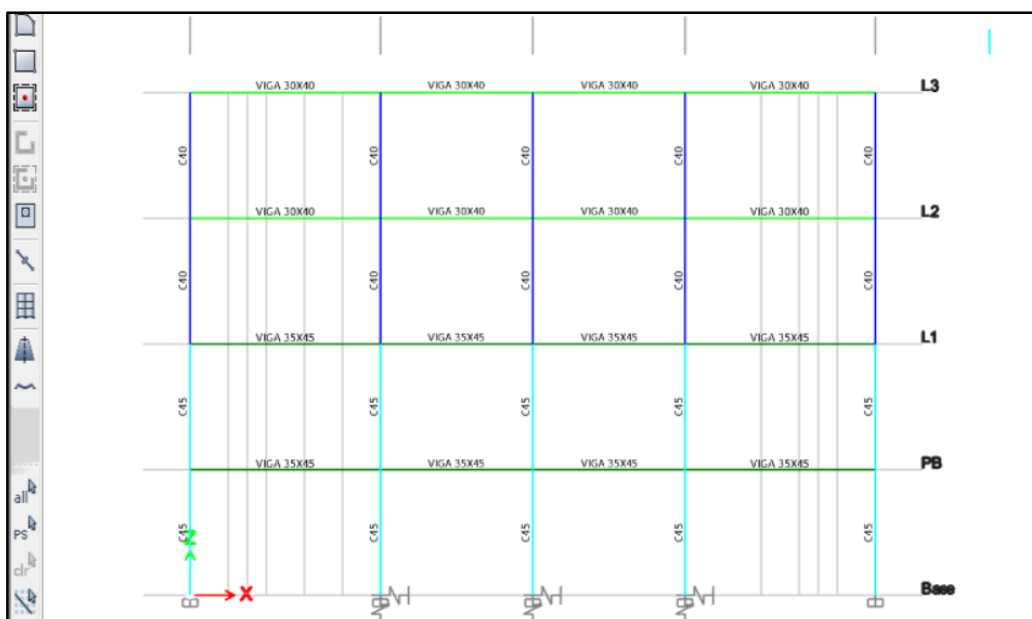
Asignación de elementos estructurales en el modelo Etabs Fuente: Elaboración Propia.
